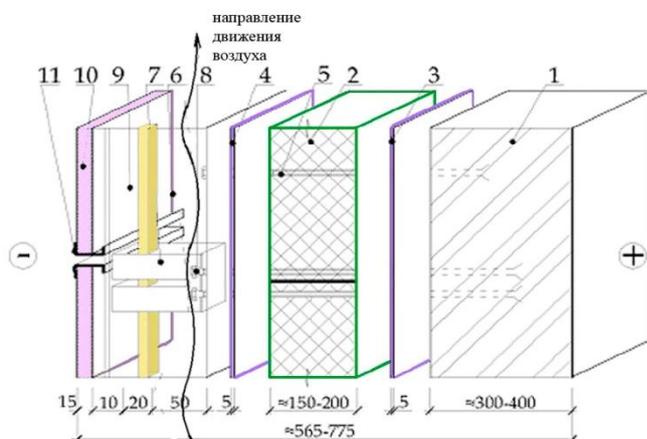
Теоретические основы разработки оптимального варианта строительных процессов и операций при монтаже навесных вентилируемых фасадов
